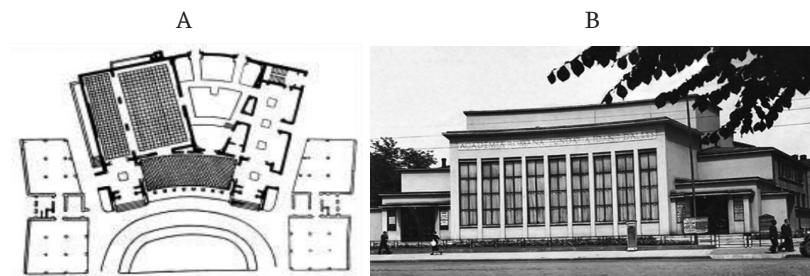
Planul parterului (A) și vedere generală (B) a sediului Fundației Ioan I. Dalles din București, proiect elaborat de arhitectul Horia Teodoru [14], [26].
